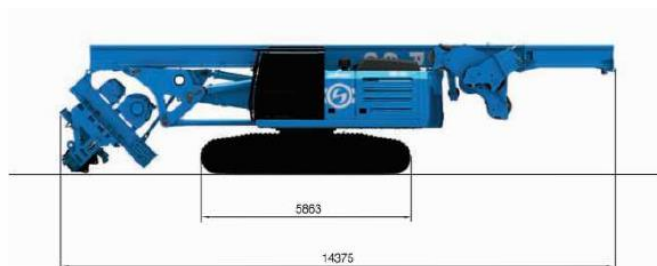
Rozmery vrtnej úpravy Klemm KR 802-3
